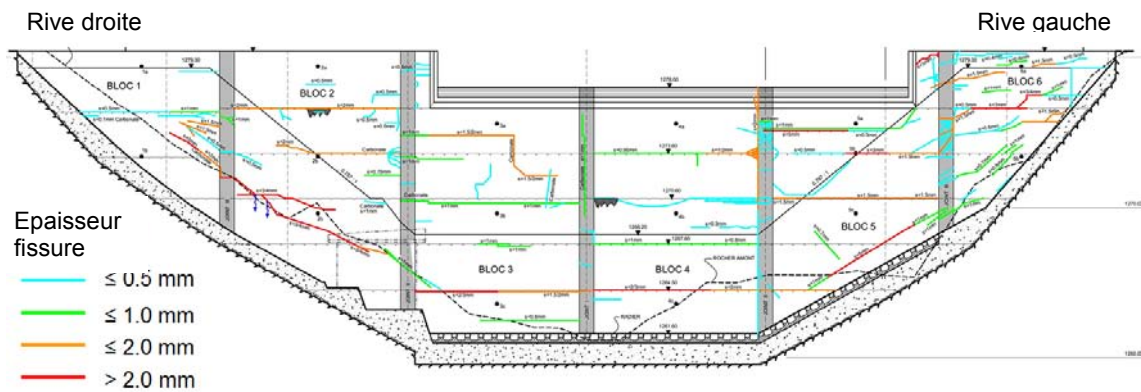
L'image des fissures dues à l'expansion de l'ancien barrage de Sera (fissures structurales) est très semblable à celle du barrage de Zeuzier (fissures suivant le contour de la vallée sur le parement aval).
